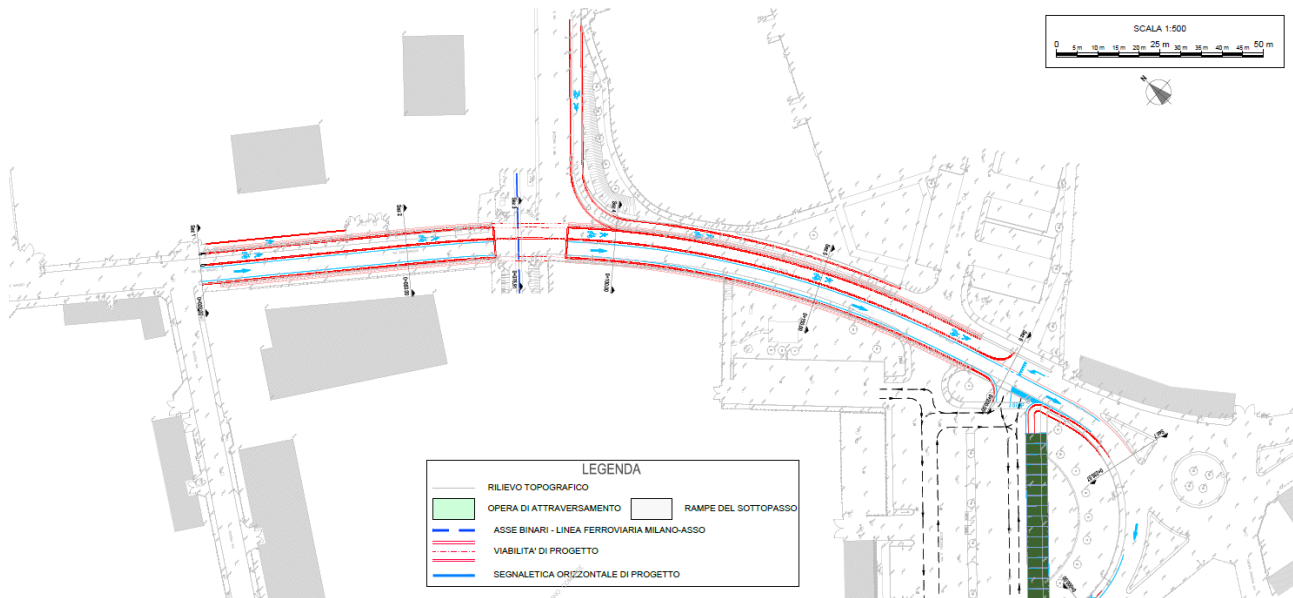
Planimetria opere di progetto sottopasso via XXIV Maggio
